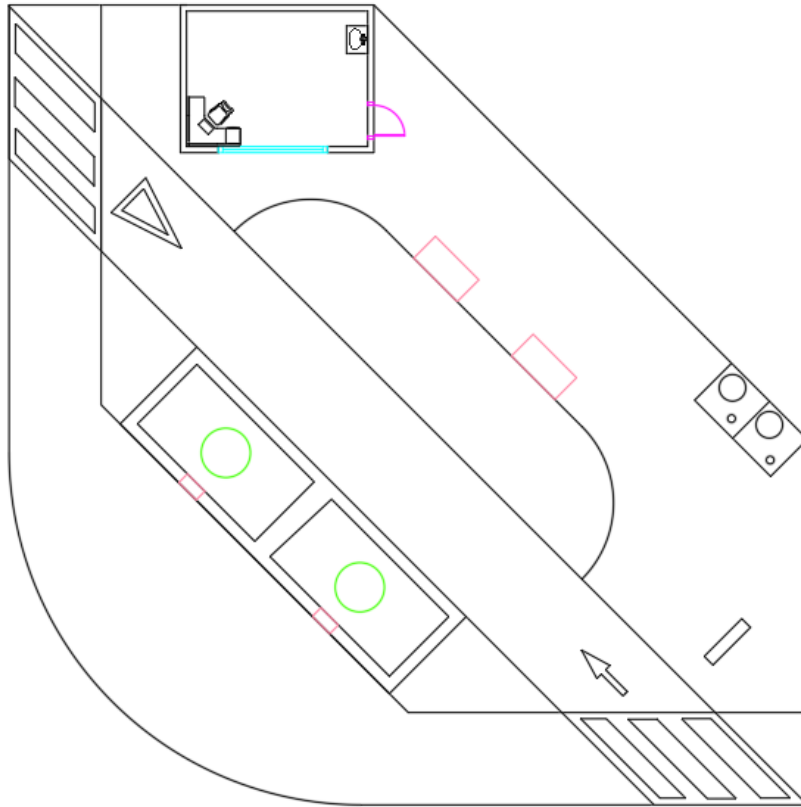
Planta de la instalación. Pr.: AutoCAD. Realización propia
